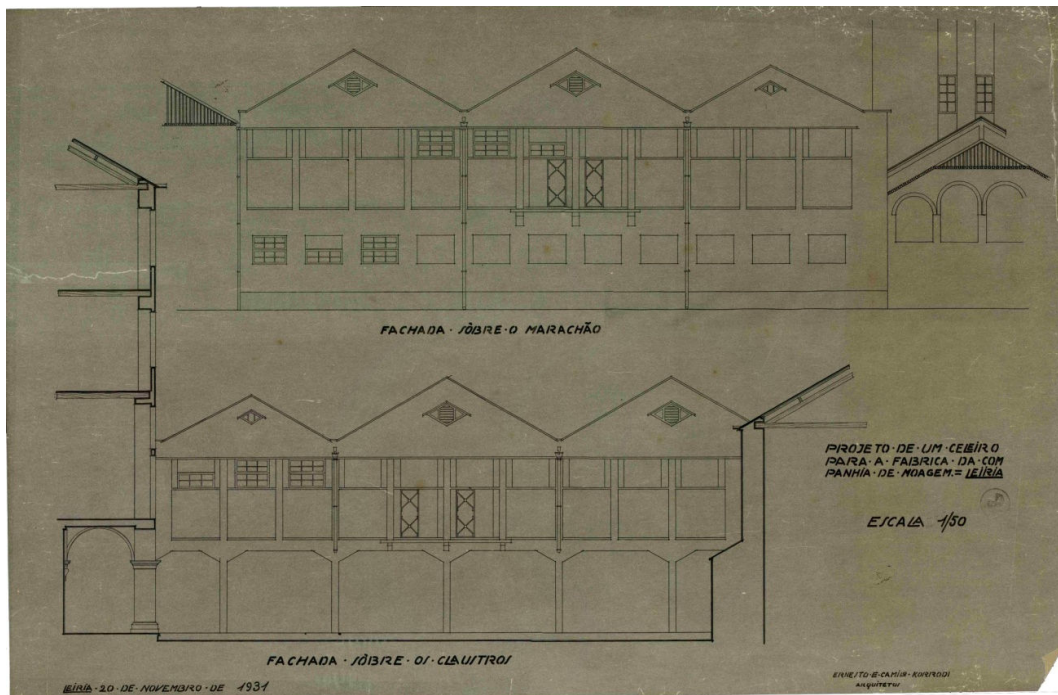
Fachadas do celeiro sobre o claustro e sobre a Rua Camilo Korrodi.
